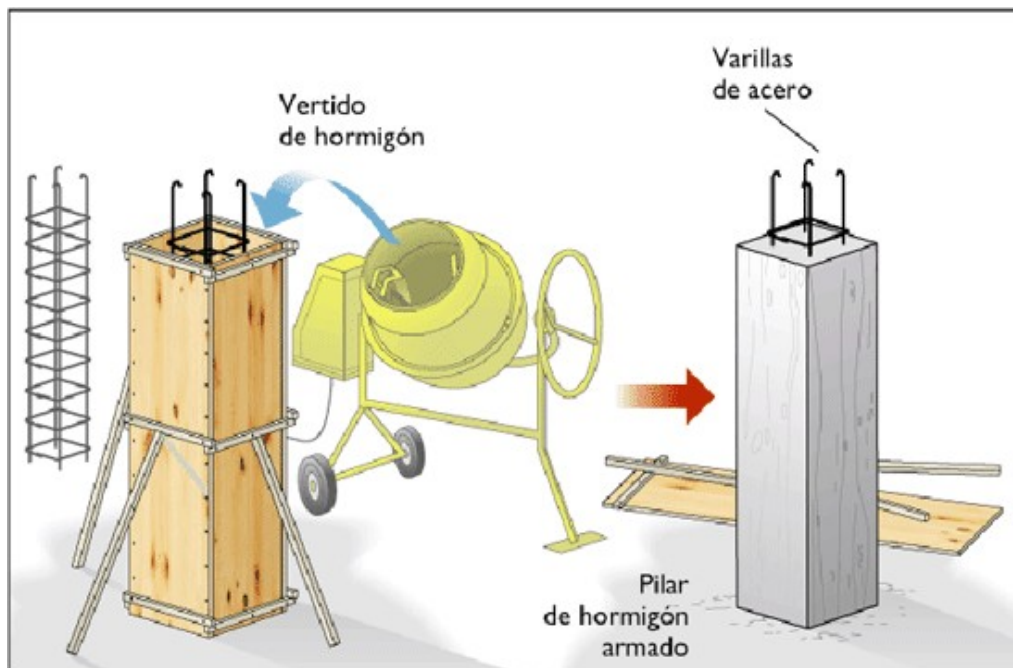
Técnica constructiva del hormigón. [C-40]
